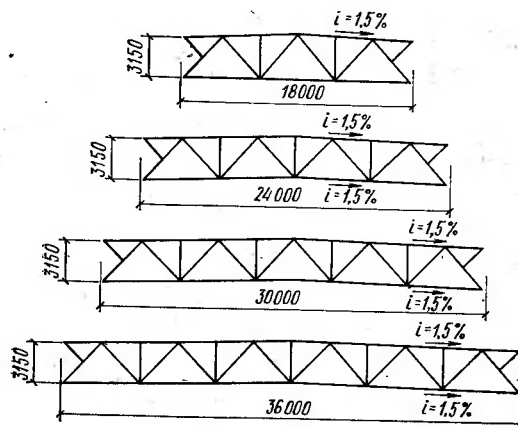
Схемы типовых стропильных ферм пролетами 18—36 м с поясами из тавров
